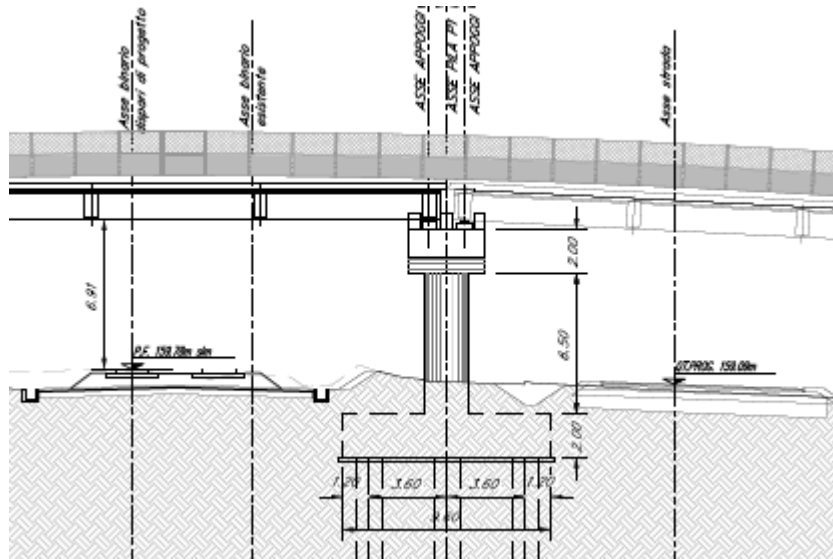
Ponte ferroviario VI01 al km 29+550: prospetto
